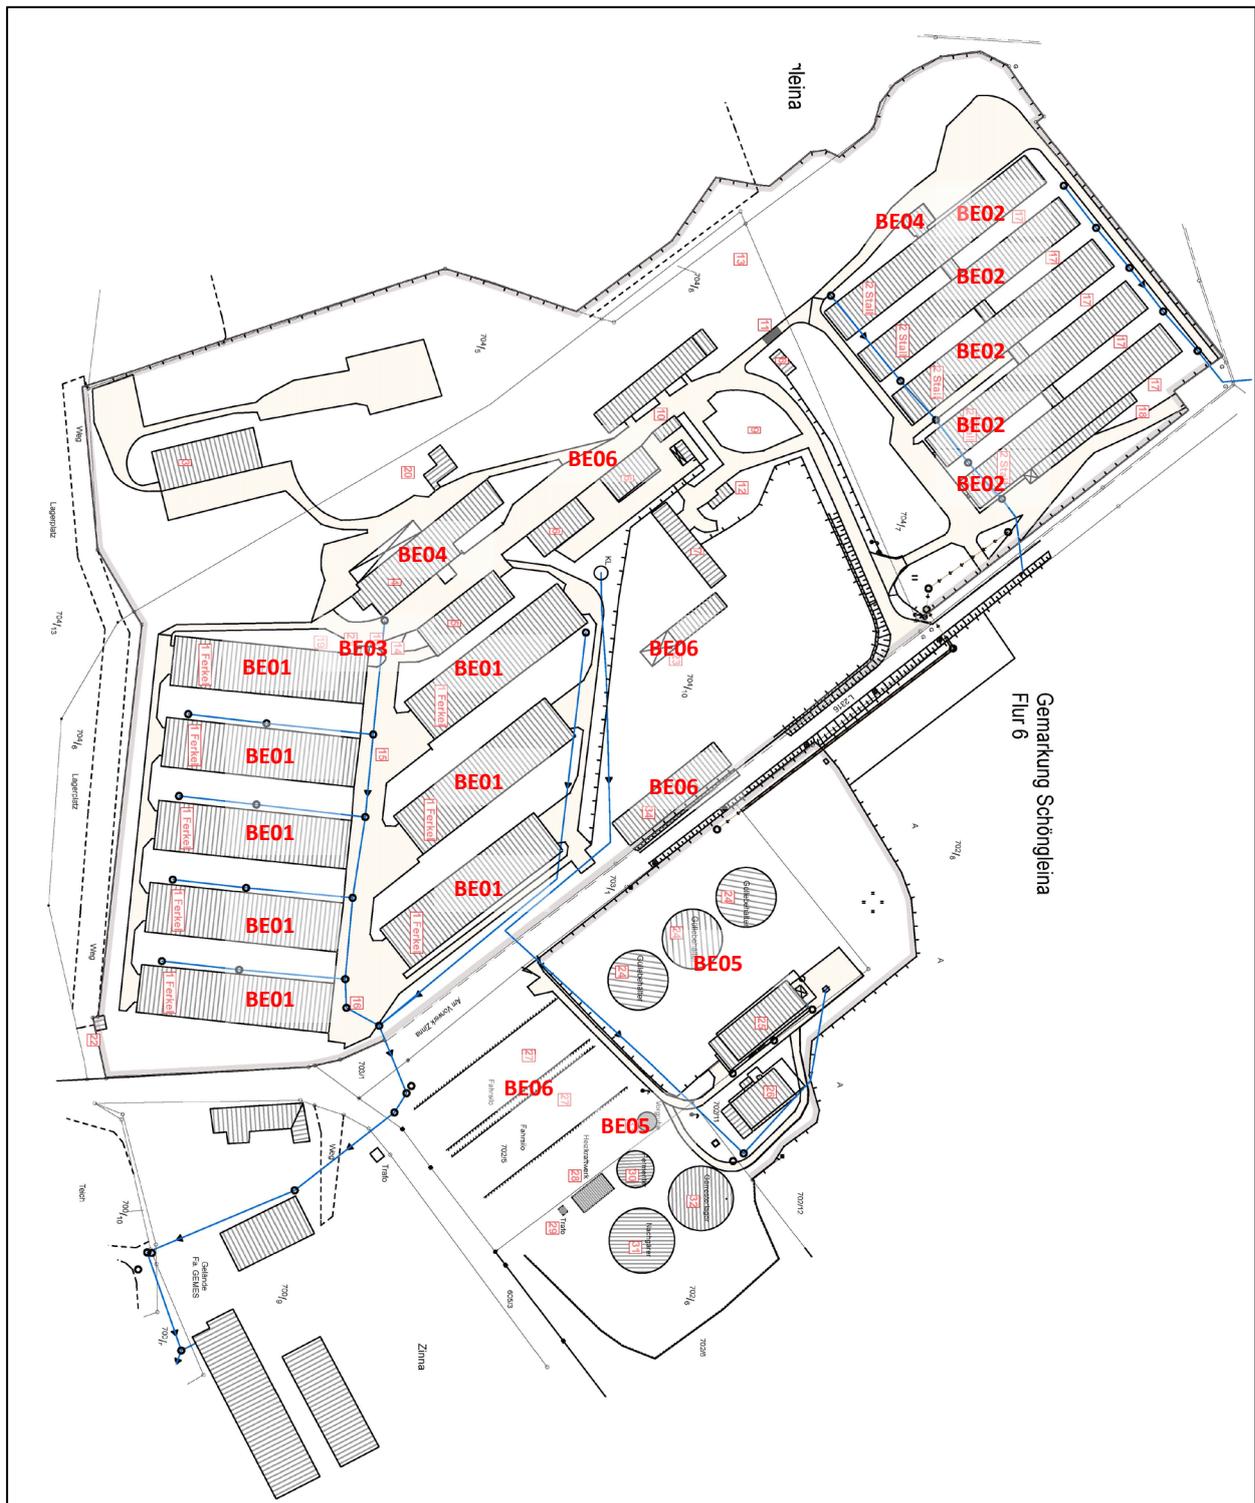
Lageplan der Anlage mit den entsprechenden Betriebseinheiten
